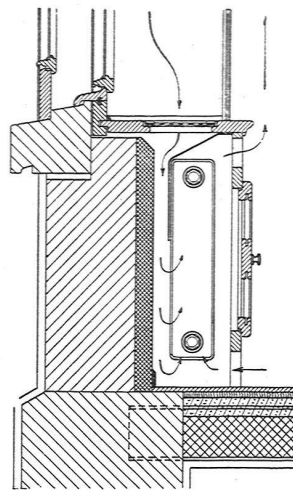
Verkleideter Fensternischenheizkörper mit richtiger Luftführung und Korkisolierung hinter dem Heizkörper.
